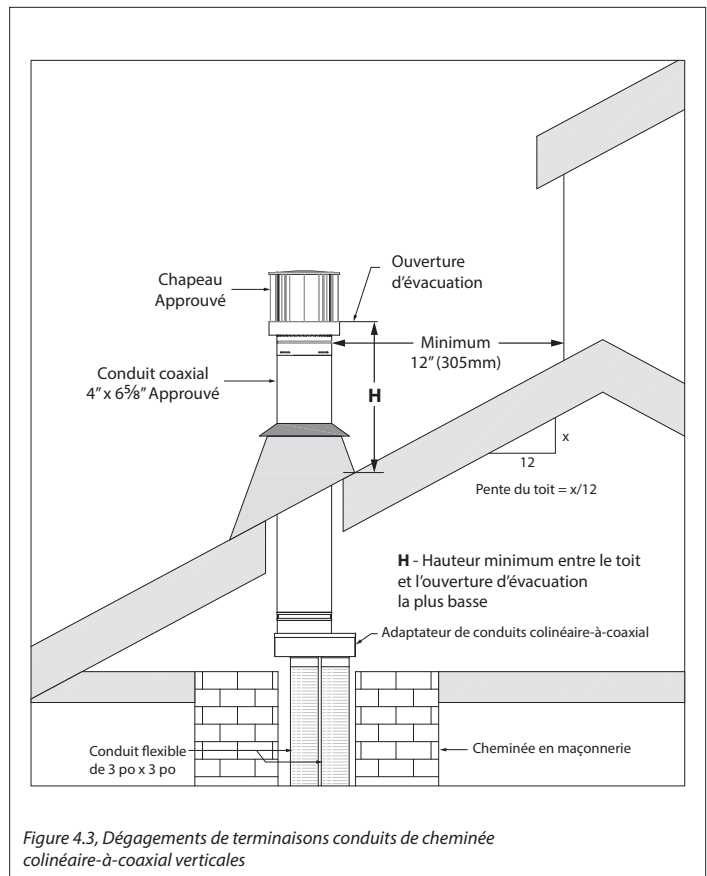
, Dégagements de terminaisons conduits de cheminée colinéaire-à-coaxial verticales
